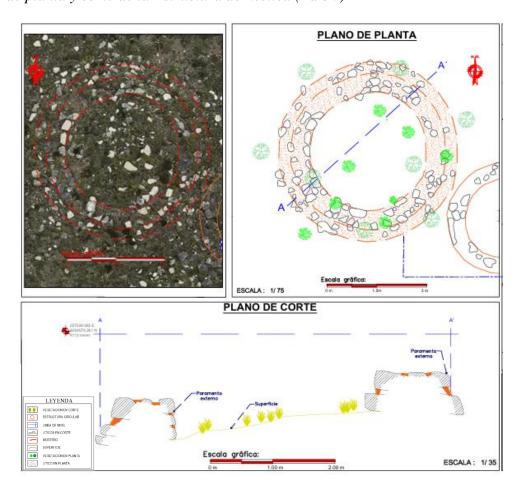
Dibujo de planta y corte de la Estructura domestica (Ed-79)
